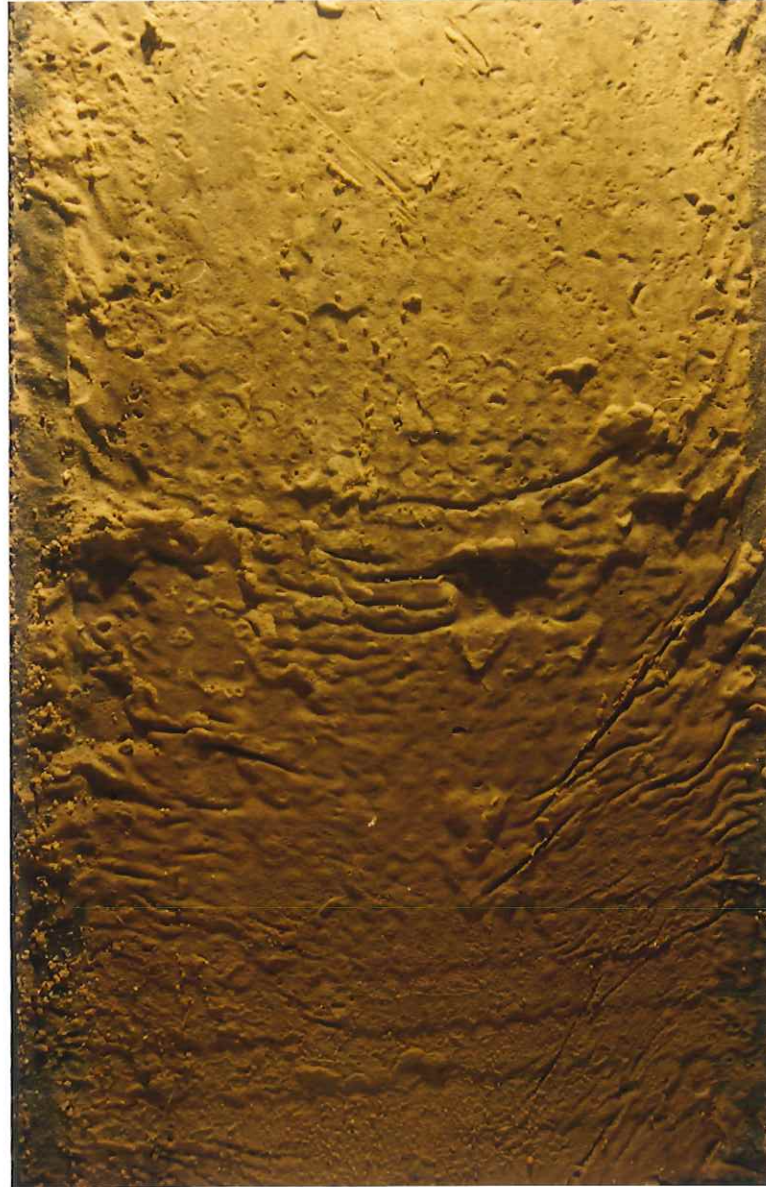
Estado final del terraplén de arena utilizando una fina tela tejida.
